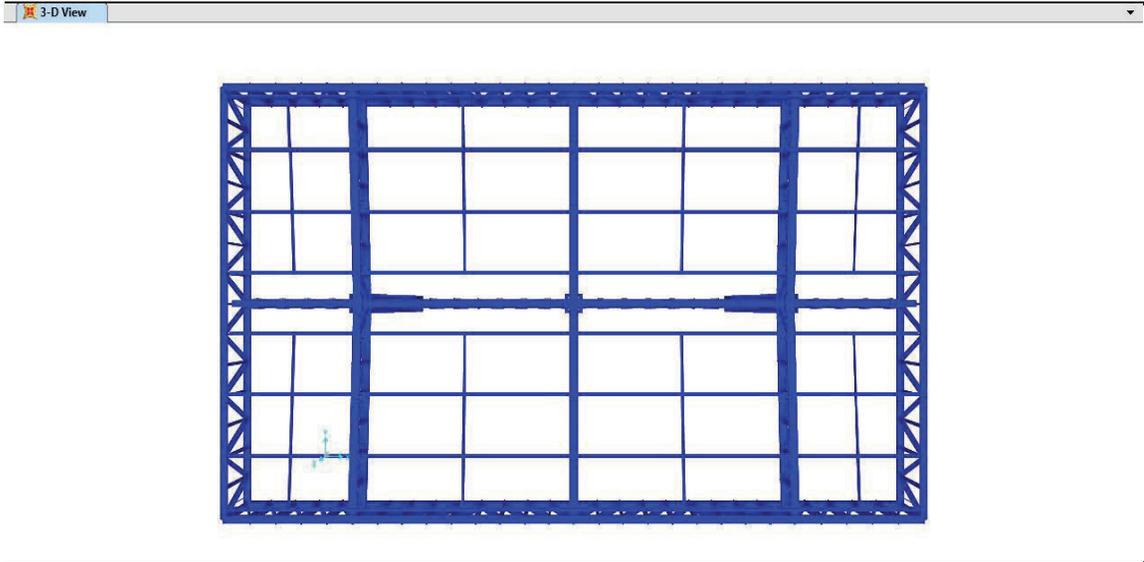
Vista 3D Planta de Cubiertas. Ref. 8
